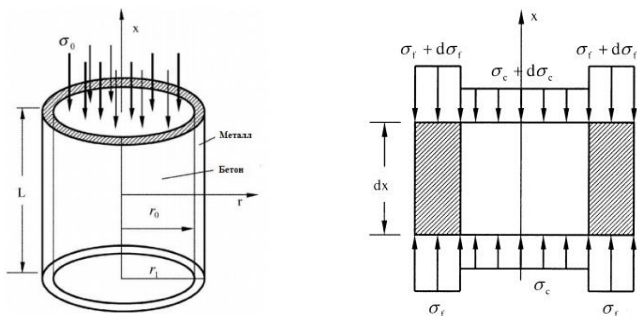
Общий вид трубобетонной колонны под нагрузкой
